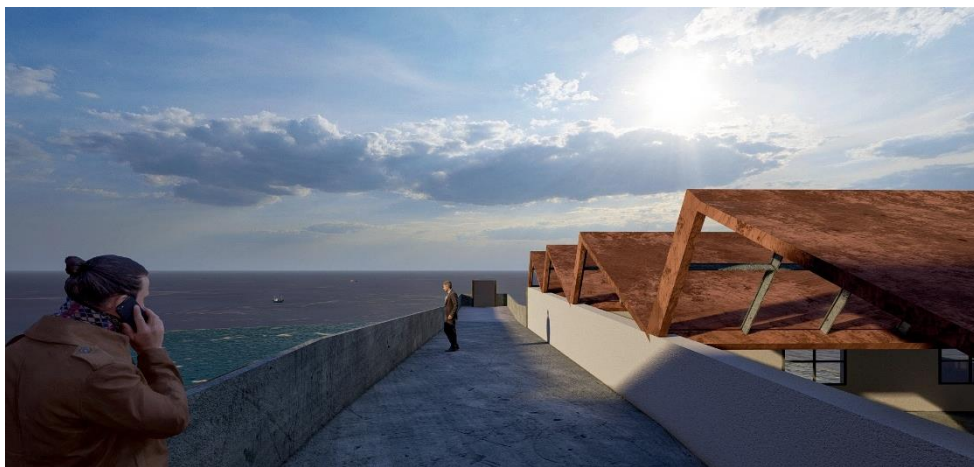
Rendu d'une vue sur mer depuis la passerelle – Source : Auteur
